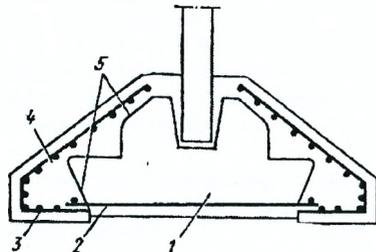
Увеличение площади подошвы кирпичного или бетонного фундамента
